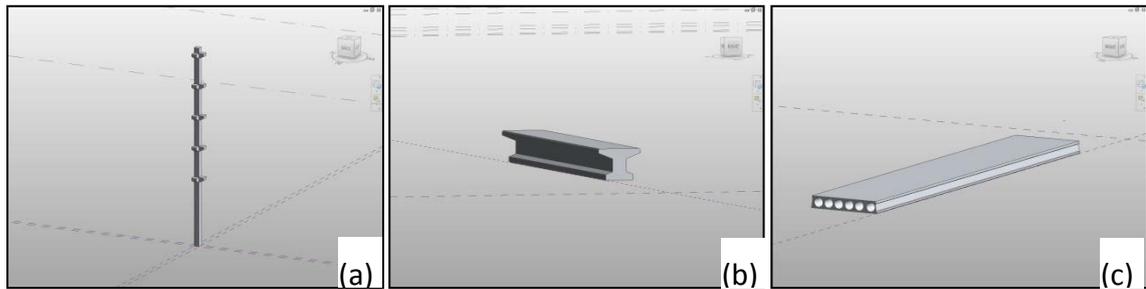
(a) – Pilar de concreto armado. (b) Viga de concreto armado. (c) Bloco de laje de concreto armado.
